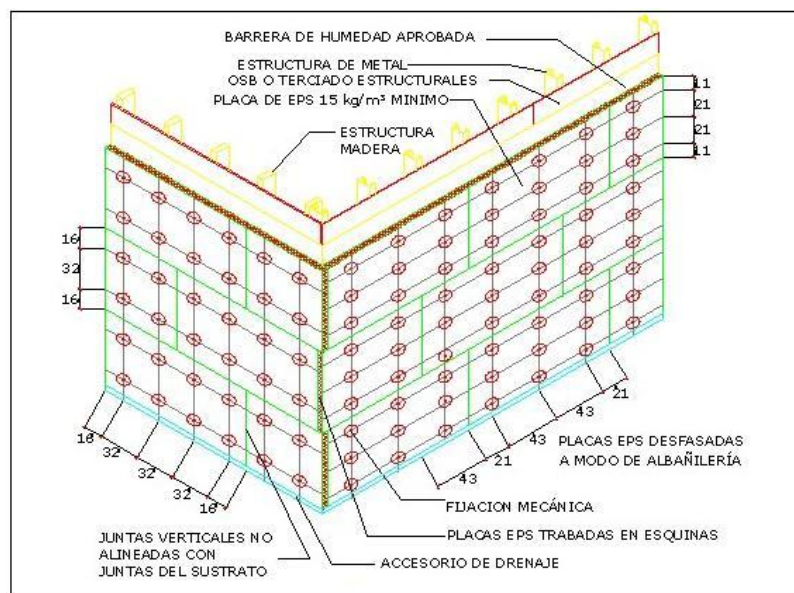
b. Ubicación de las placas aislantes en EIFS con drenaje (fijación mecánica)
